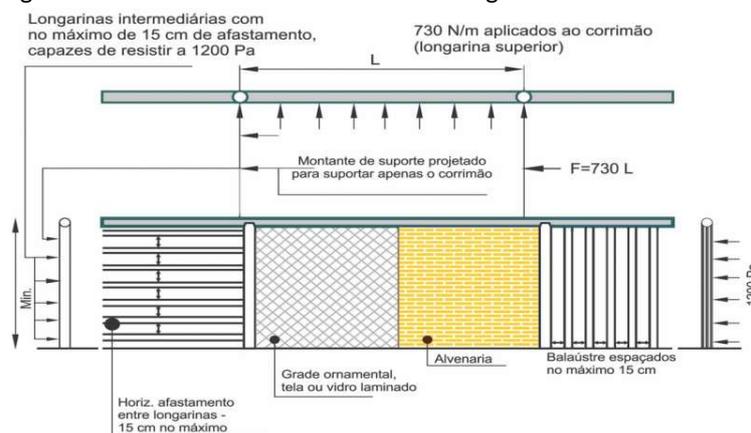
Detalhamento construtivo da instalação de guardas com as cargas mínimas a que eles deverão resistir.
